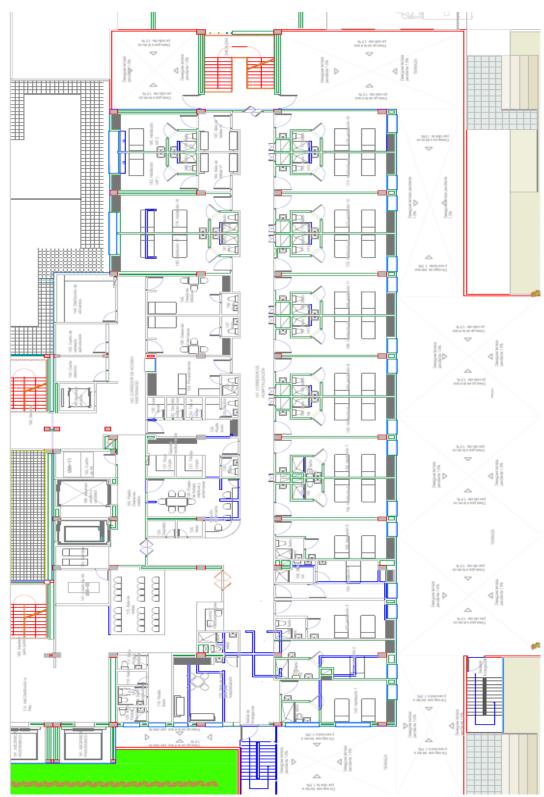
Planta existente piso 3. Fuente: Gobernación de Arauca
